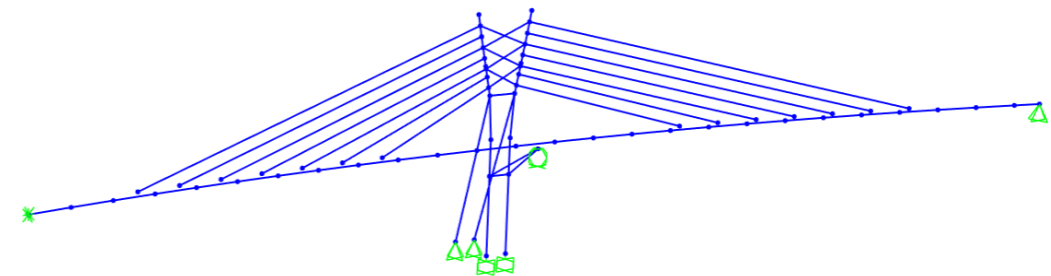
Simetría de la estructura de la pasarela para el cálculo de tesado. Fuente: Elaboración Propia (SAP2000)
